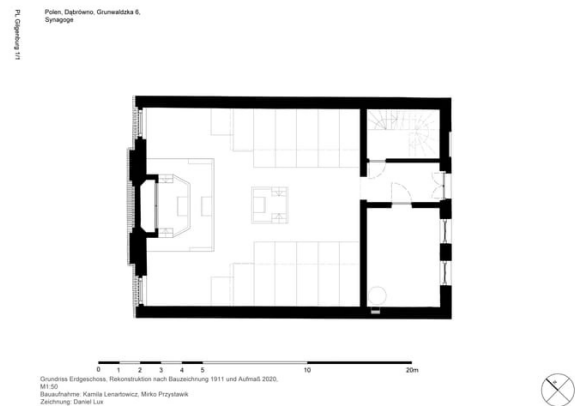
Polen, Dąbrówno, Grunwaldzka 6, Synagoge Grundriss Erdgeschoss
